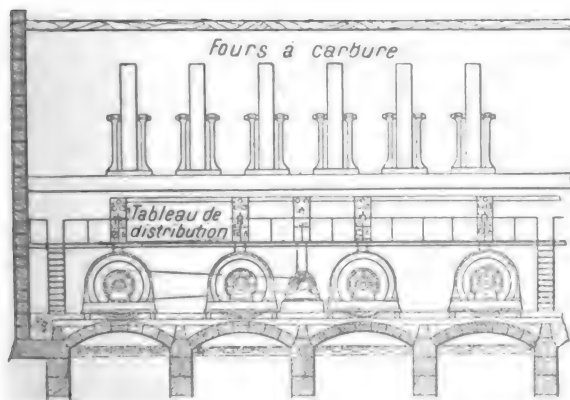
et 5. — Coupe longitudinale et plan d'un des groupes.
